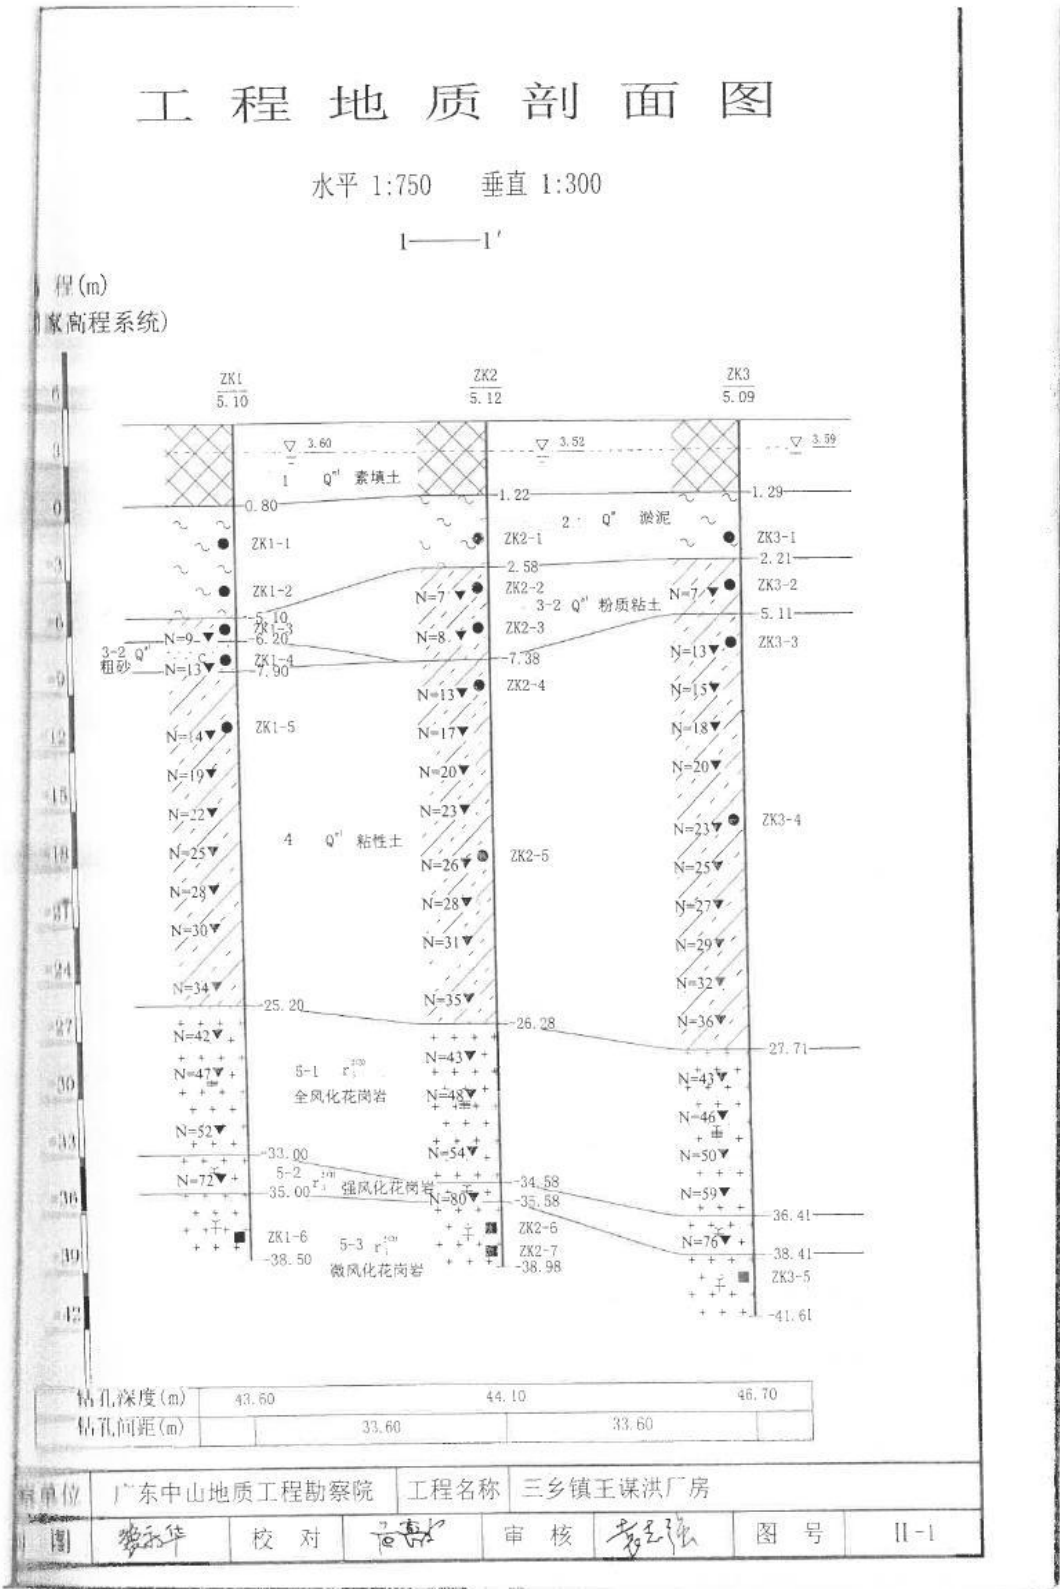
岩土勘察工程地质剖面图 (1-1 剖面)
